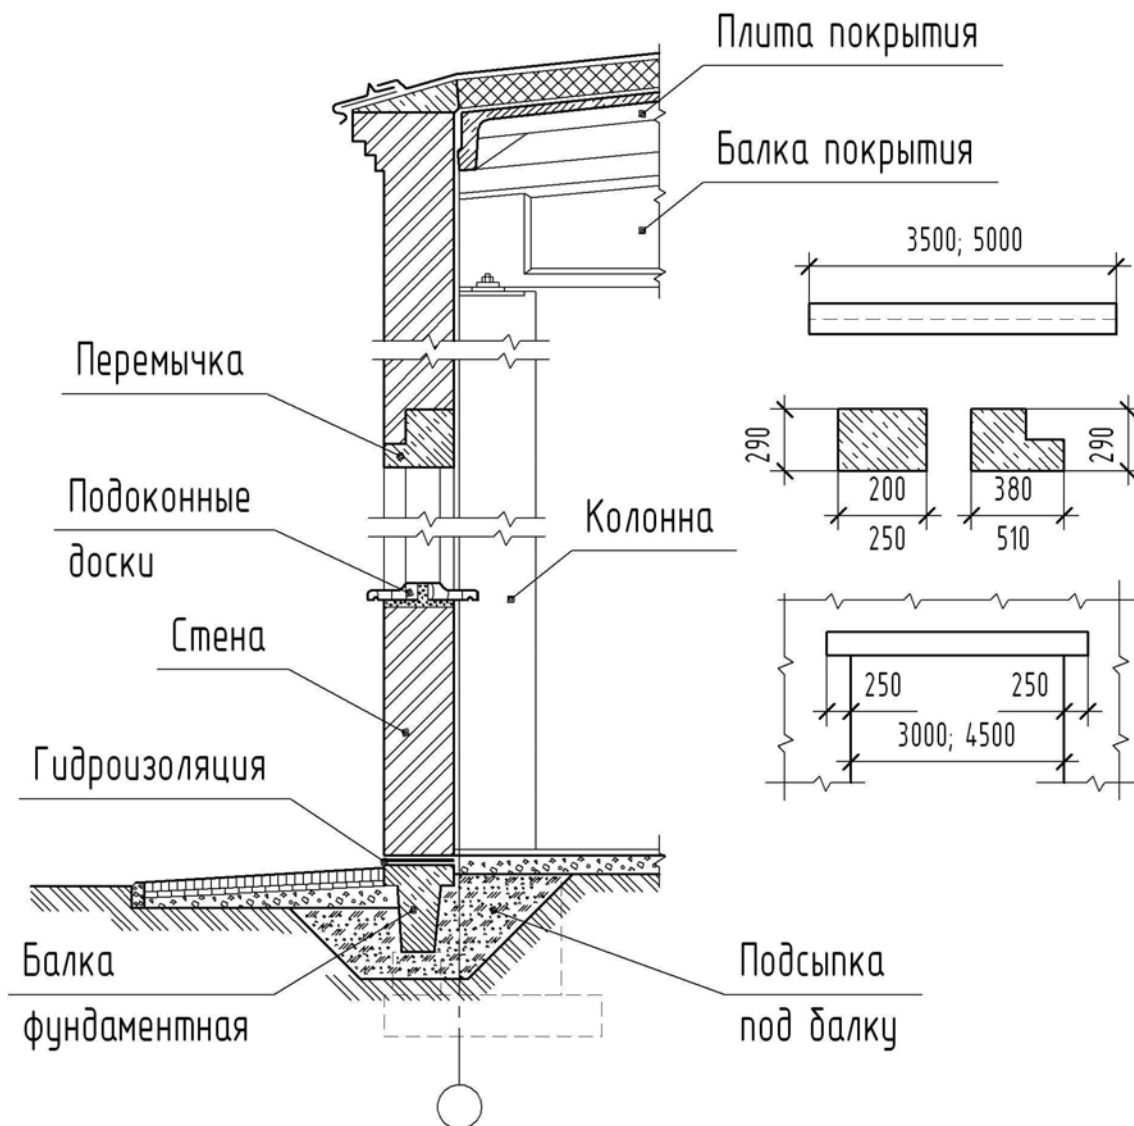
Перемычки кирпичных стен промышленных зданий
